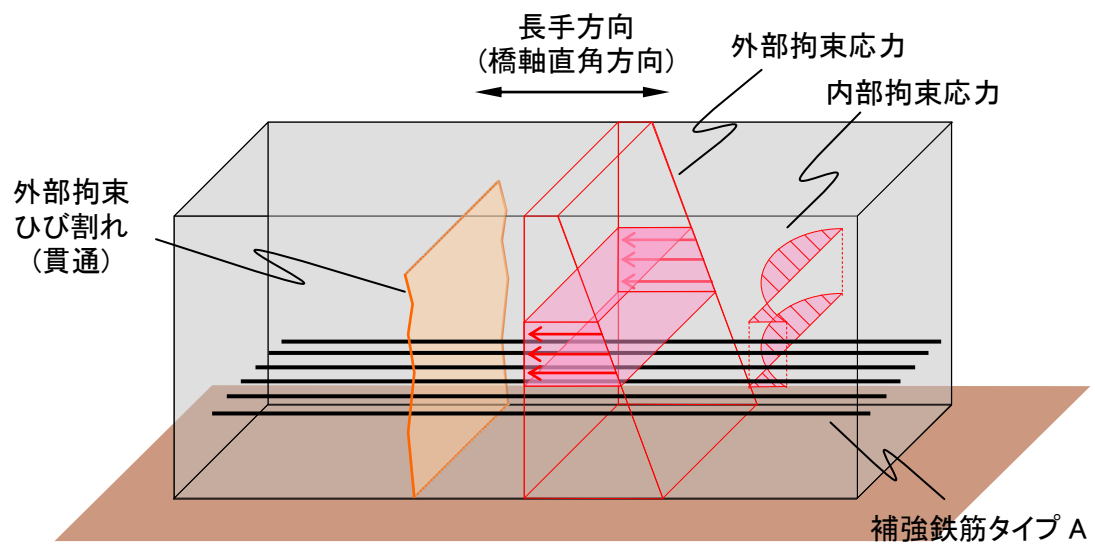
ひび割れ発生方向と抵抗鉄筋概要図（補強鉄筋タイプ A）
